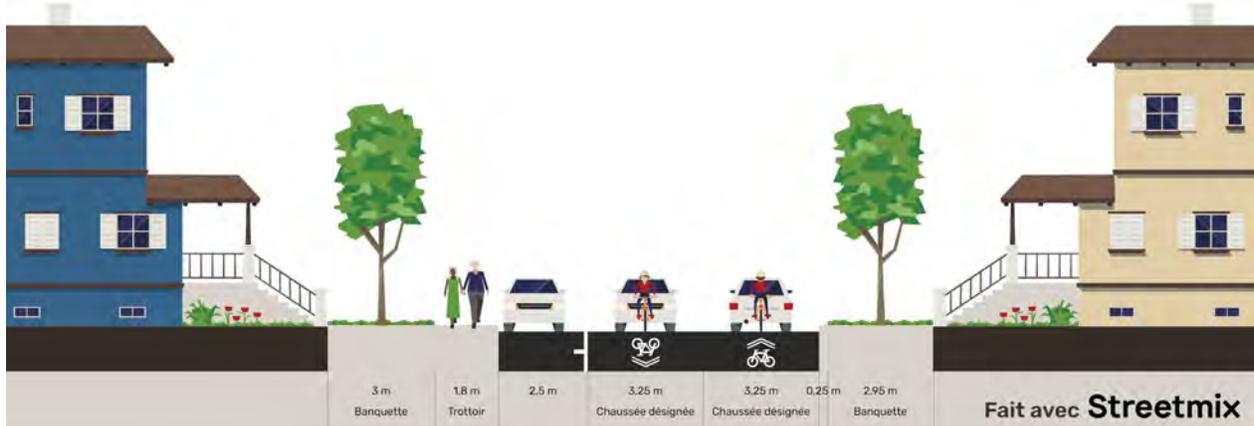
Coupe LR-03 : rue avec chaussée de 9,0 m et trottoir
